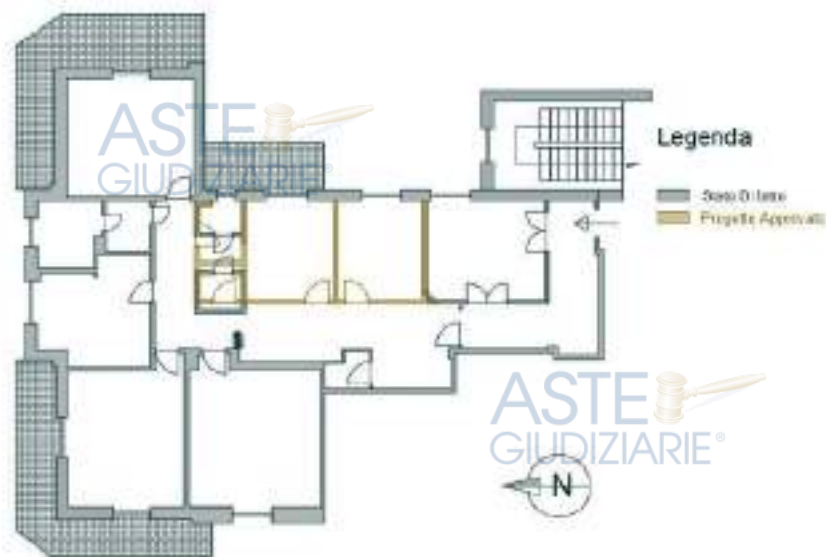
Planimetria di Confronto tra lo stato di fatto e lo Stato di progetto approvato.
